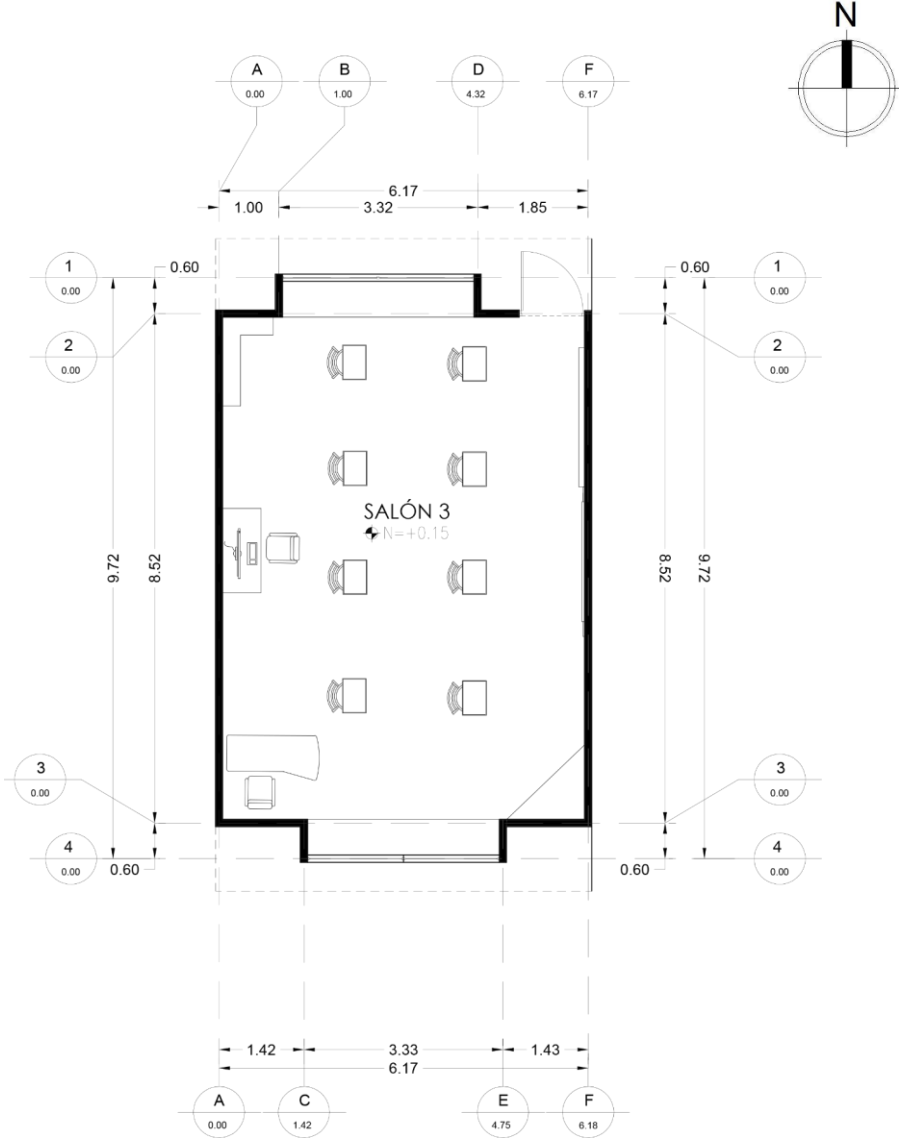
Imagen Ilustrativa de planta arquitectónica de Preescolar A.
